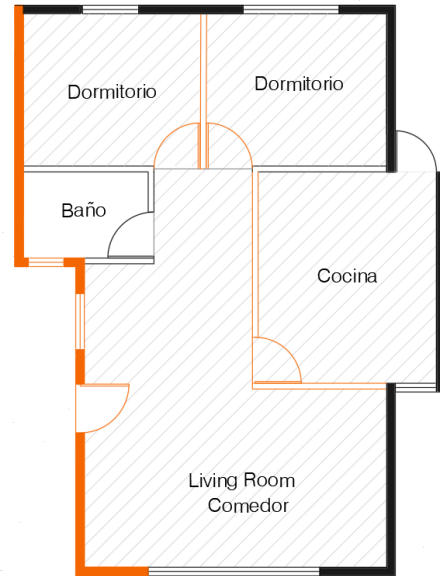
Configuración en planta Fuente: Elaboración Propia.
